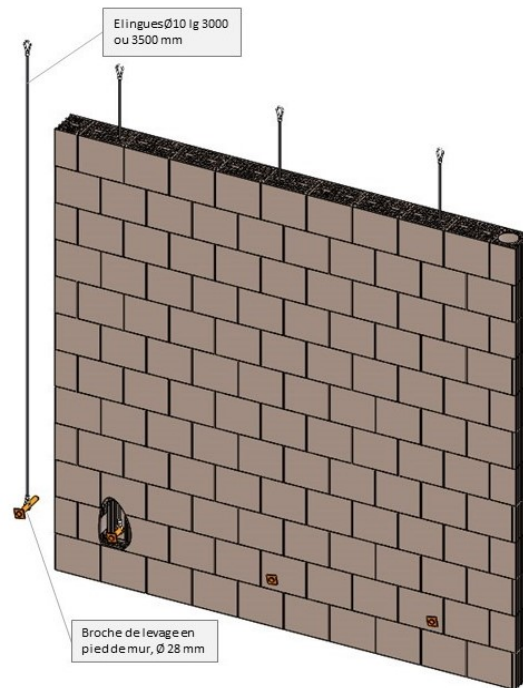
Détail élingage MUR TERRE CUITE PREFAXIS
